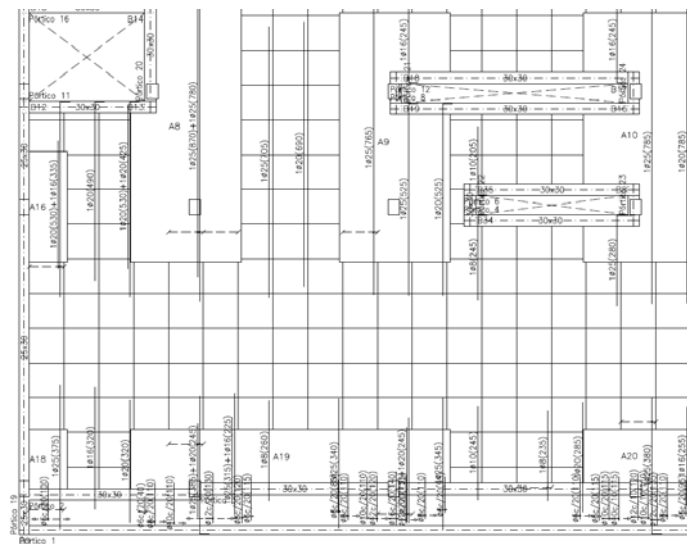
Armadura transversal superior necesaria previamente a la intervención
